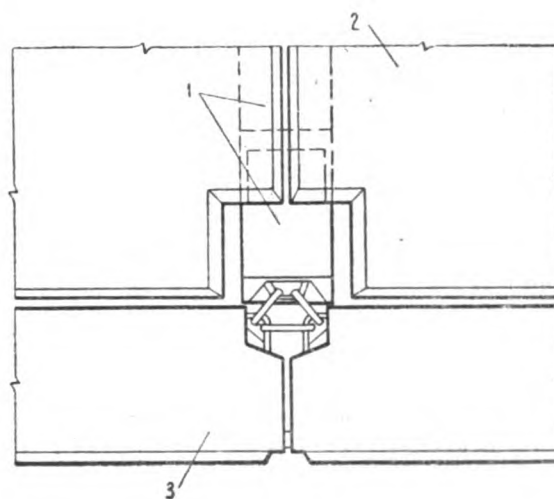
Соединение элементов каркаса с панелями наружных стен
